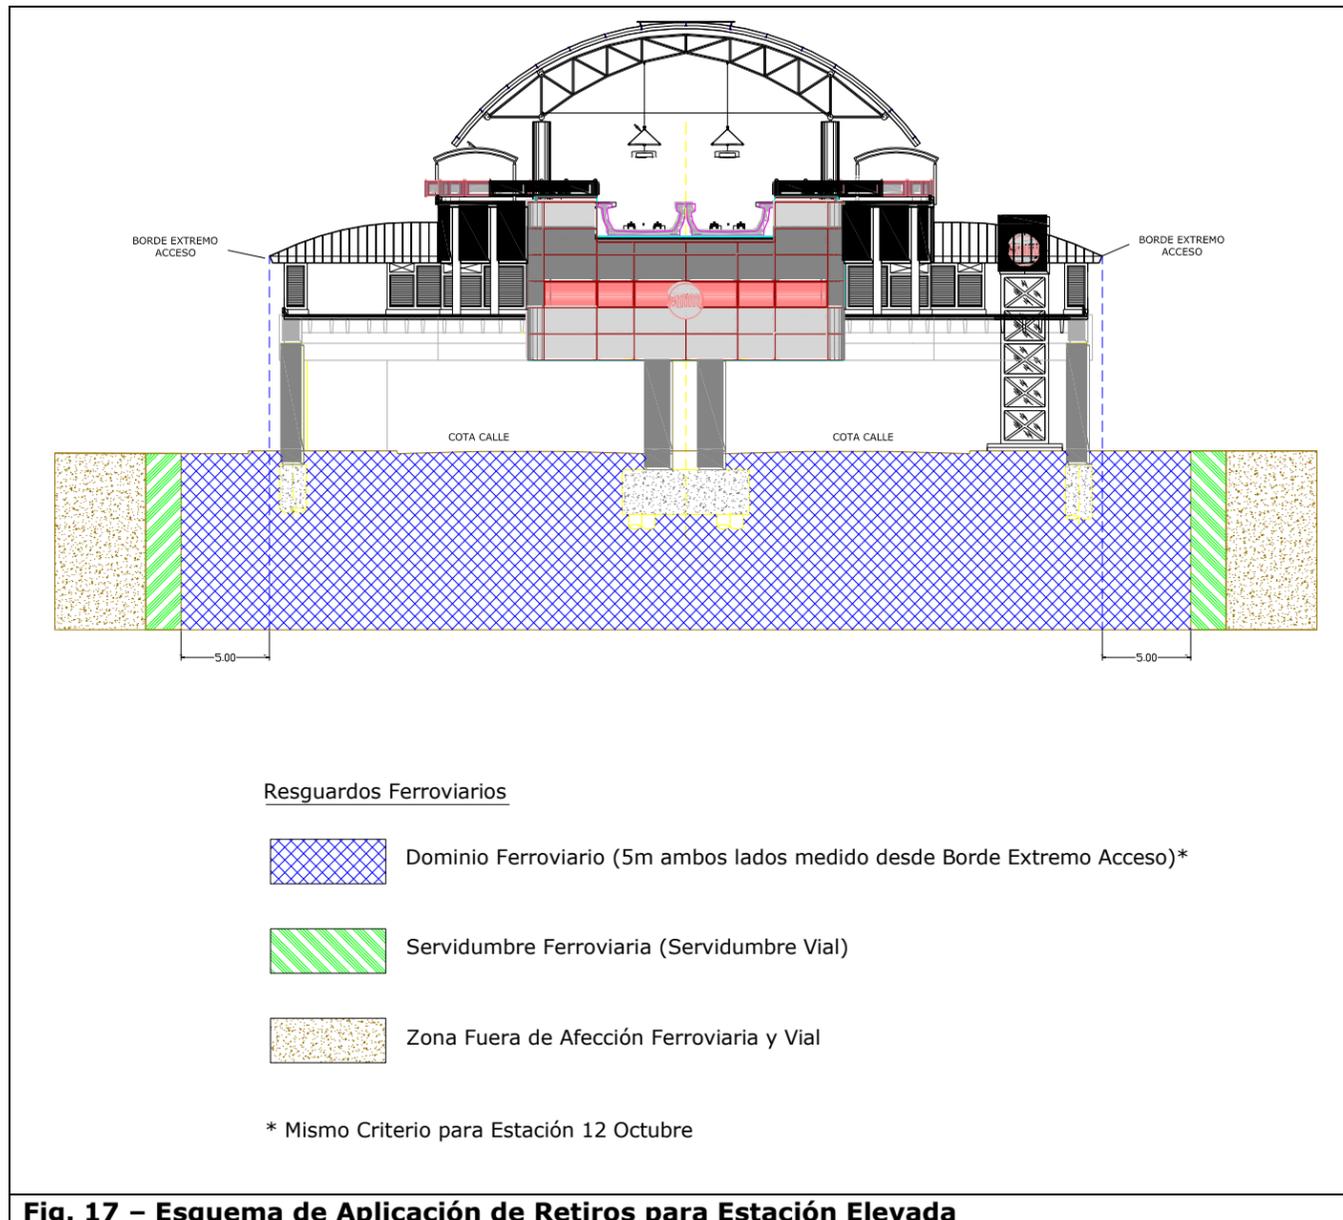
Esquema de Aplicación de Retiros para Estación Elevada
